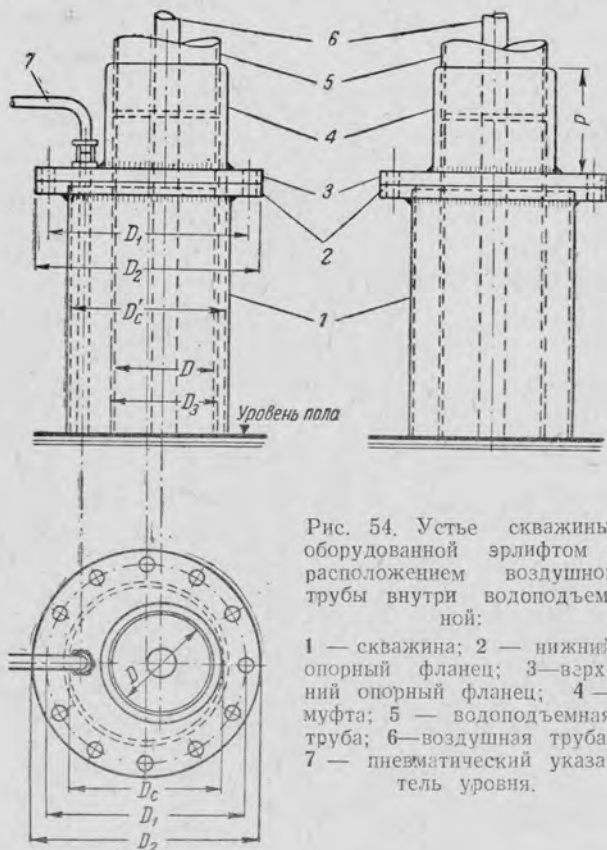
Устье скважины, оборудованной эрлифтом с расположением воздушной трубы внутри водоподъемной:
